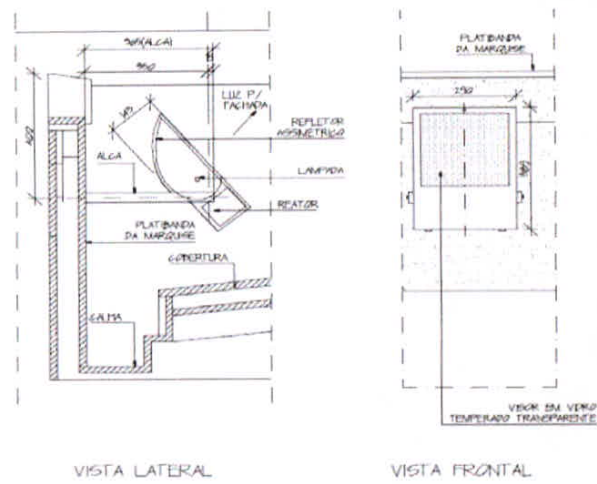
Corte esquemático da marquise detalhando a iluminação da fachada.
